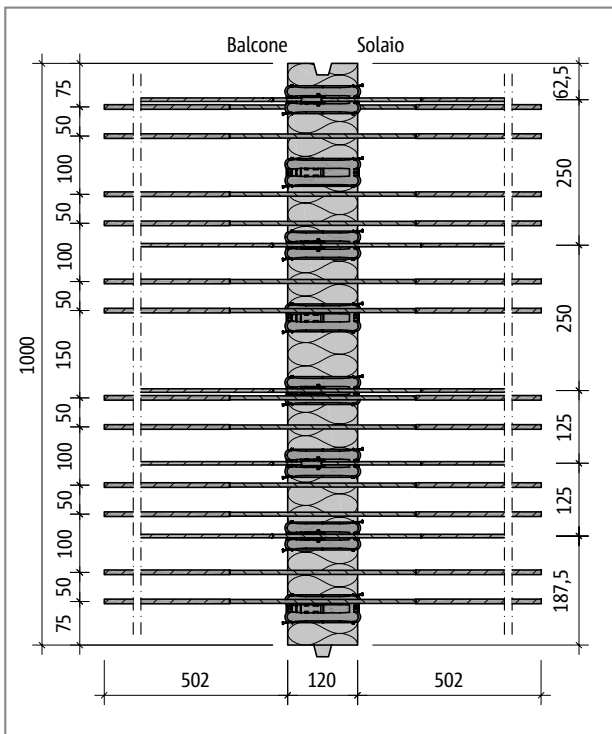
Schöck Isokorb® tipo KXT40: pianta del prodotto
